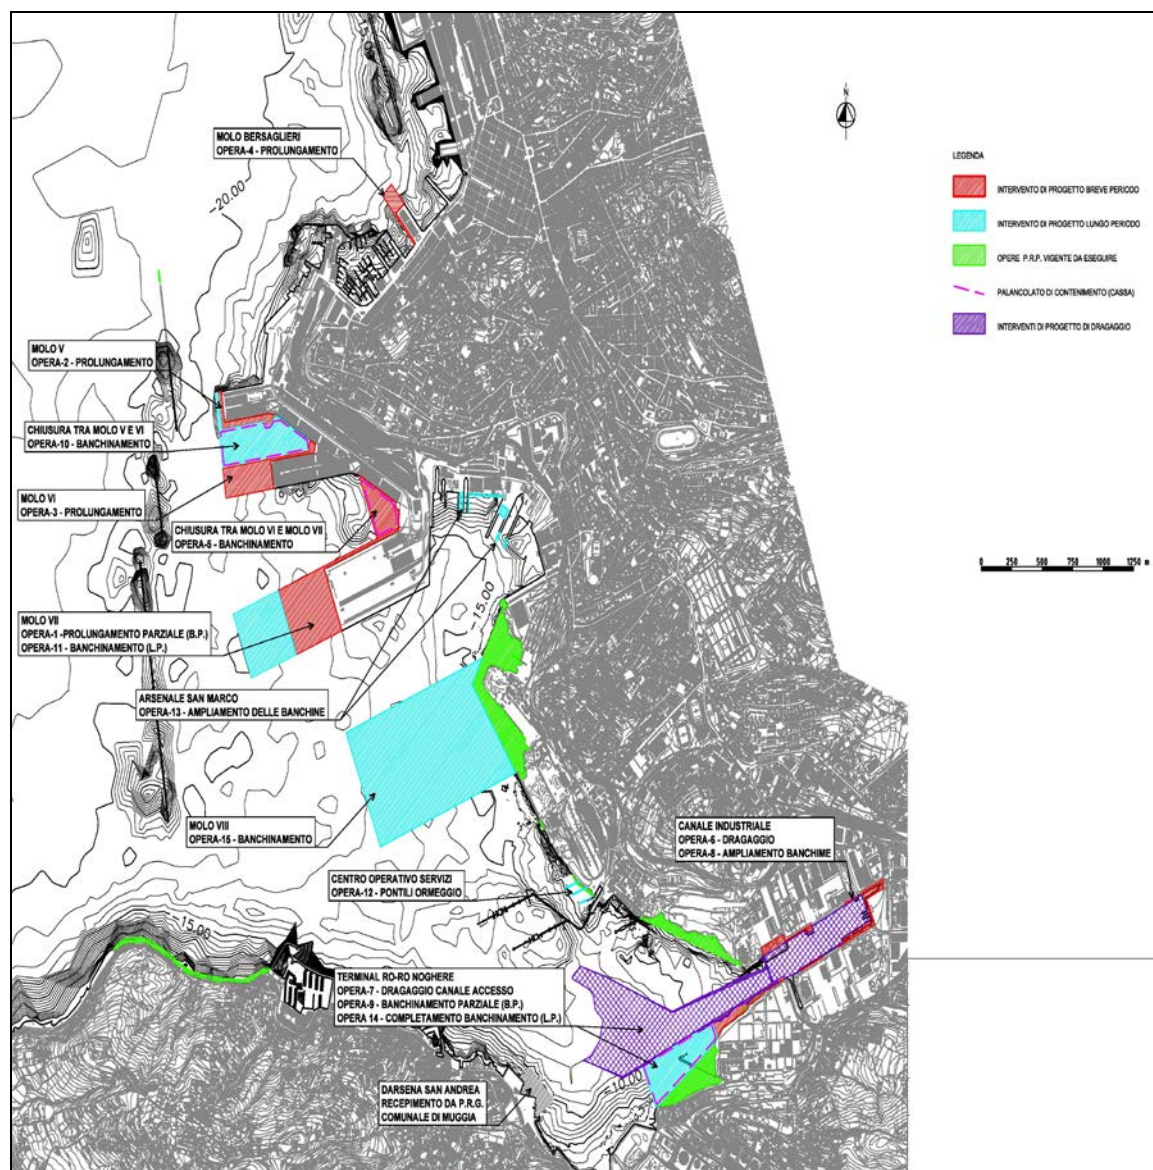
PLANIMETRIA DEGLI INTERVENTI DI BREVE E LUNGO PERIODO
